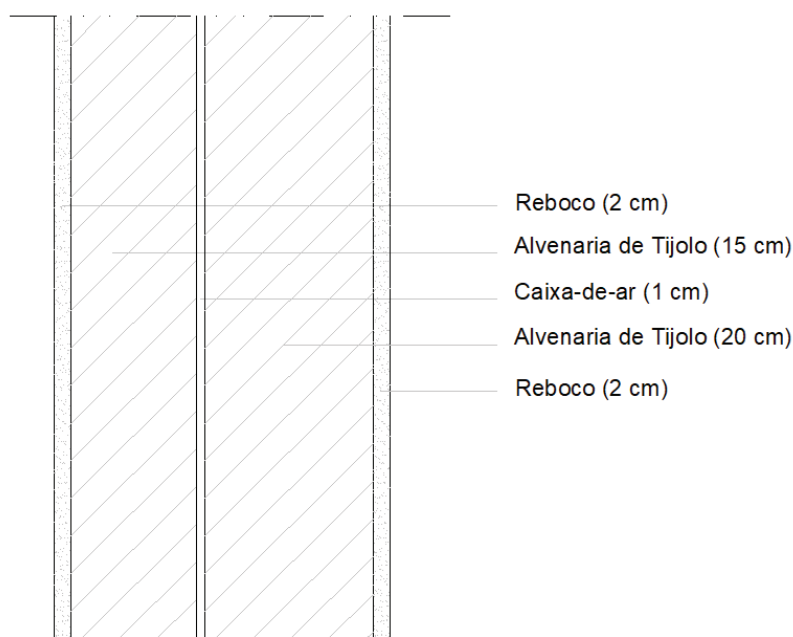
Pormenor construtivo da parede interior tipo V (circulação)
